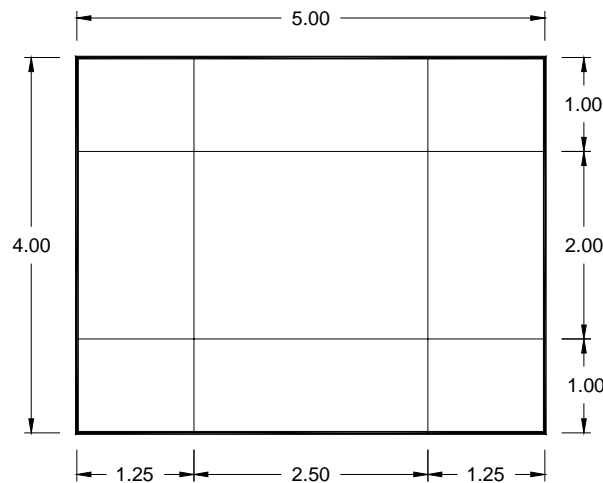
Tablero Tipo de losa tapa (acotaciones en metros)
